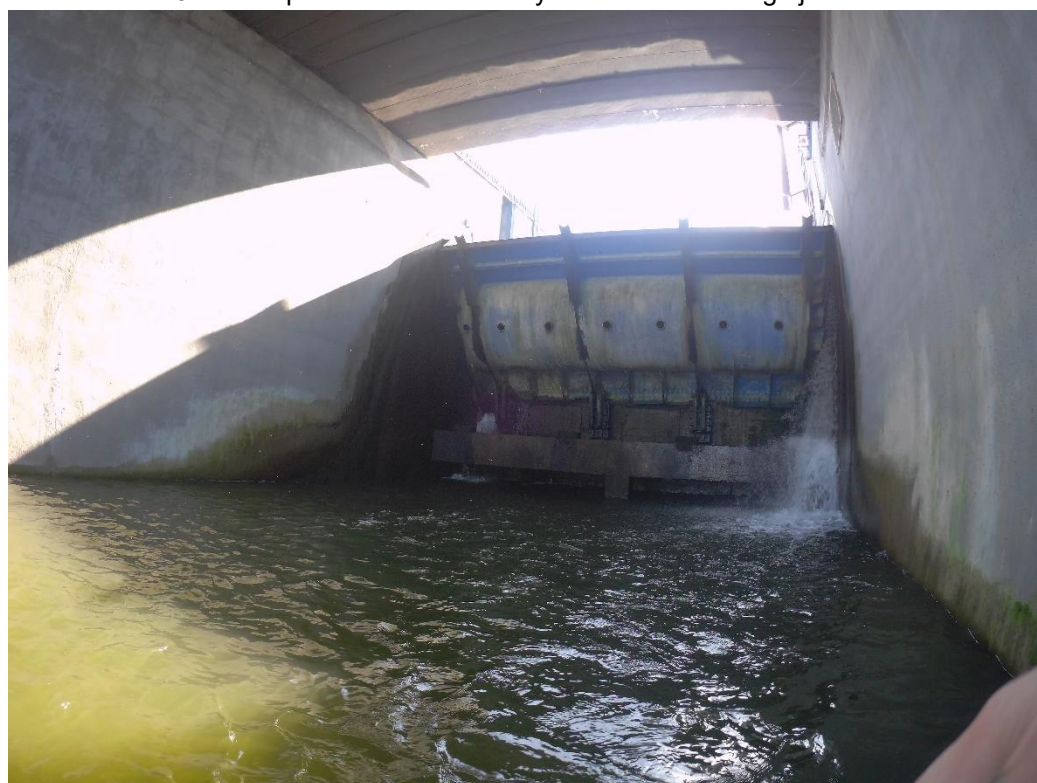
Filar środkowy - widok powierzchni betonowych w prawym przęśle jazu.
